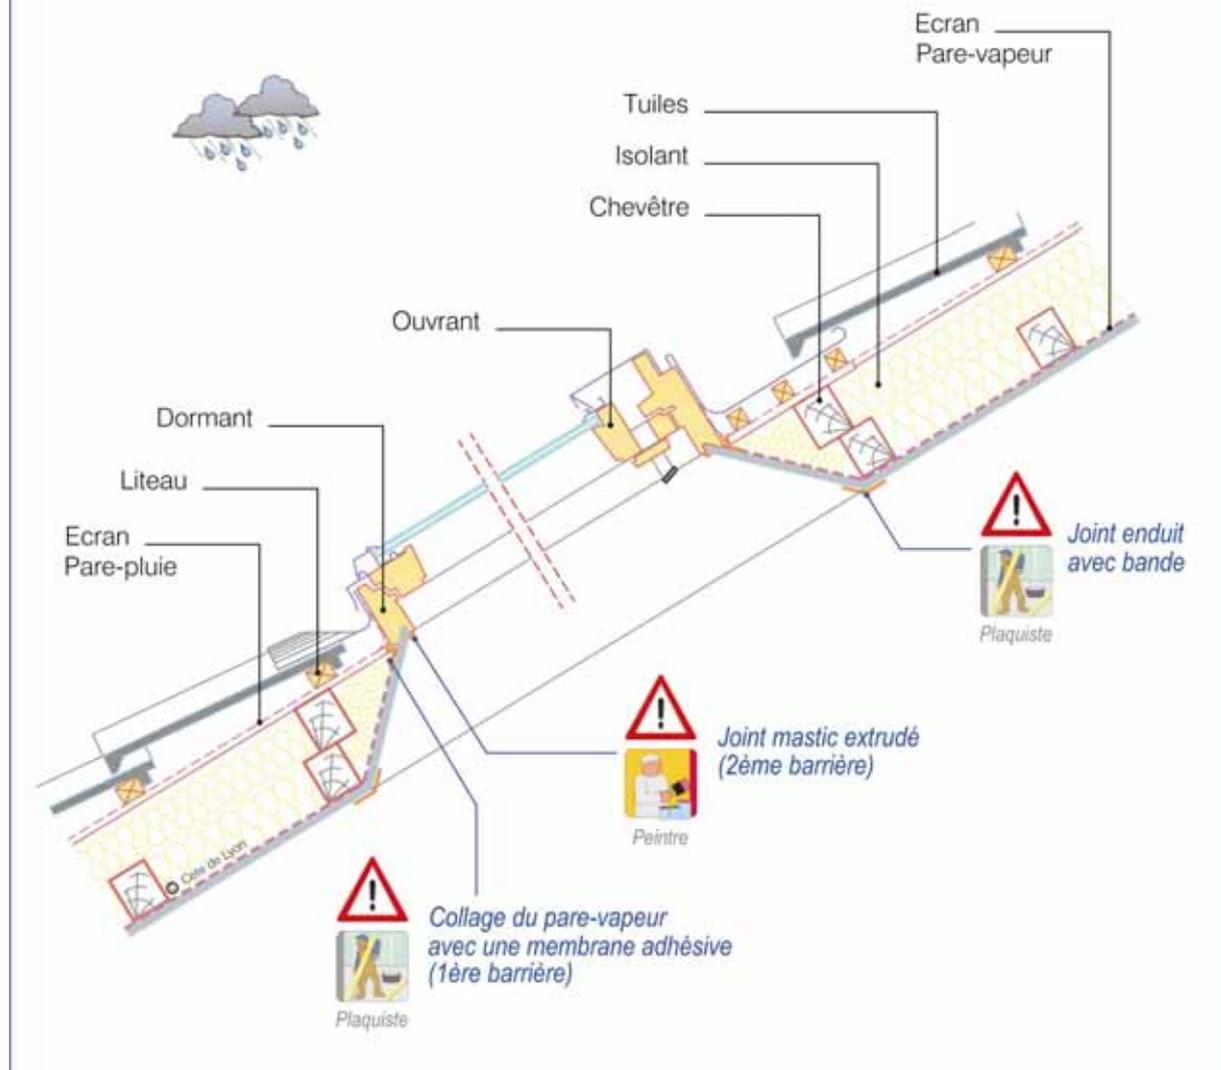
Liaison fenêtre de toiture en plafond-combles
